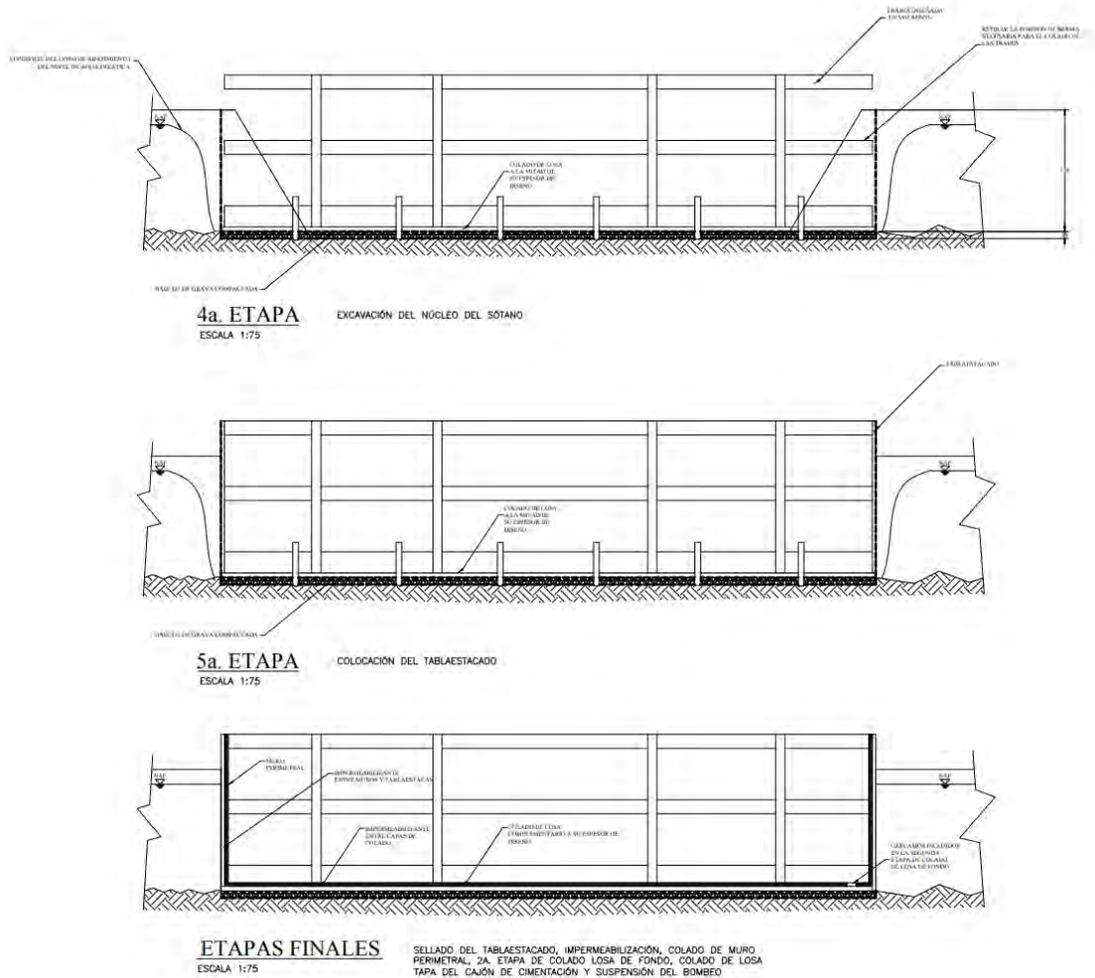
Plano constructivo de las excavaciones de sótanos etapas finales.
